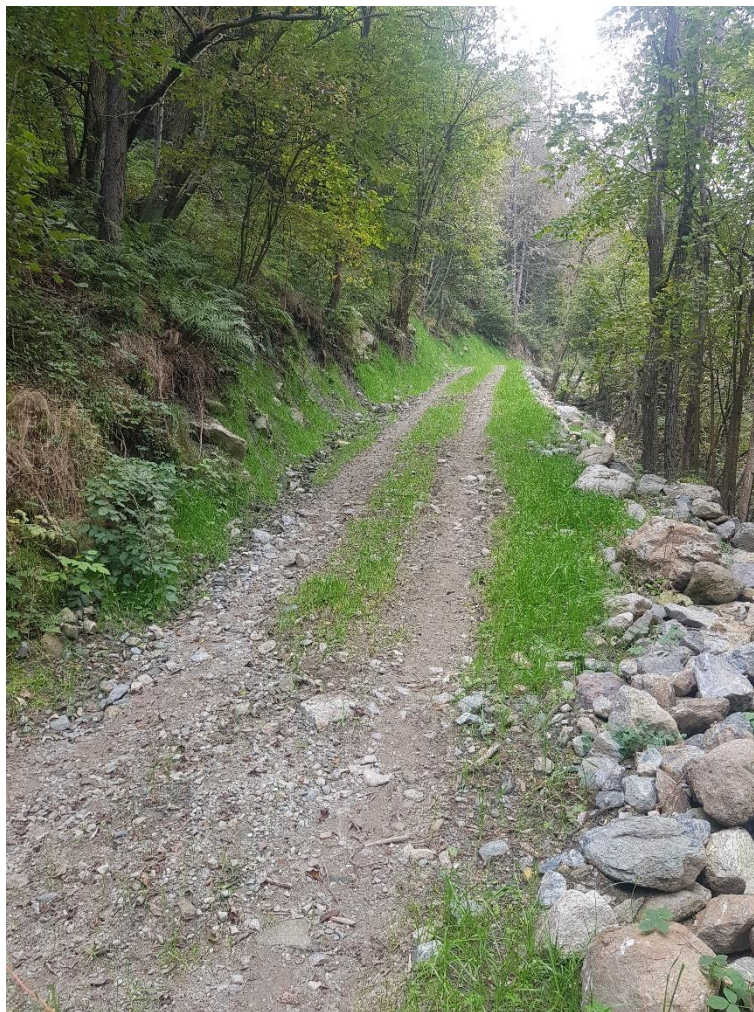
e 6: sistemazioni finali pista e camera di carico con inerbimenti eseguiti
